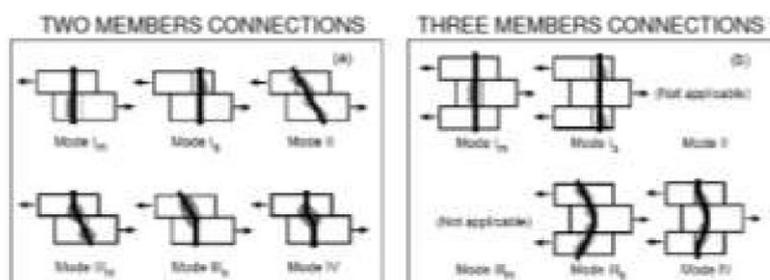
tipos de conexiones con bambú laminado con 2 y 3 sección
